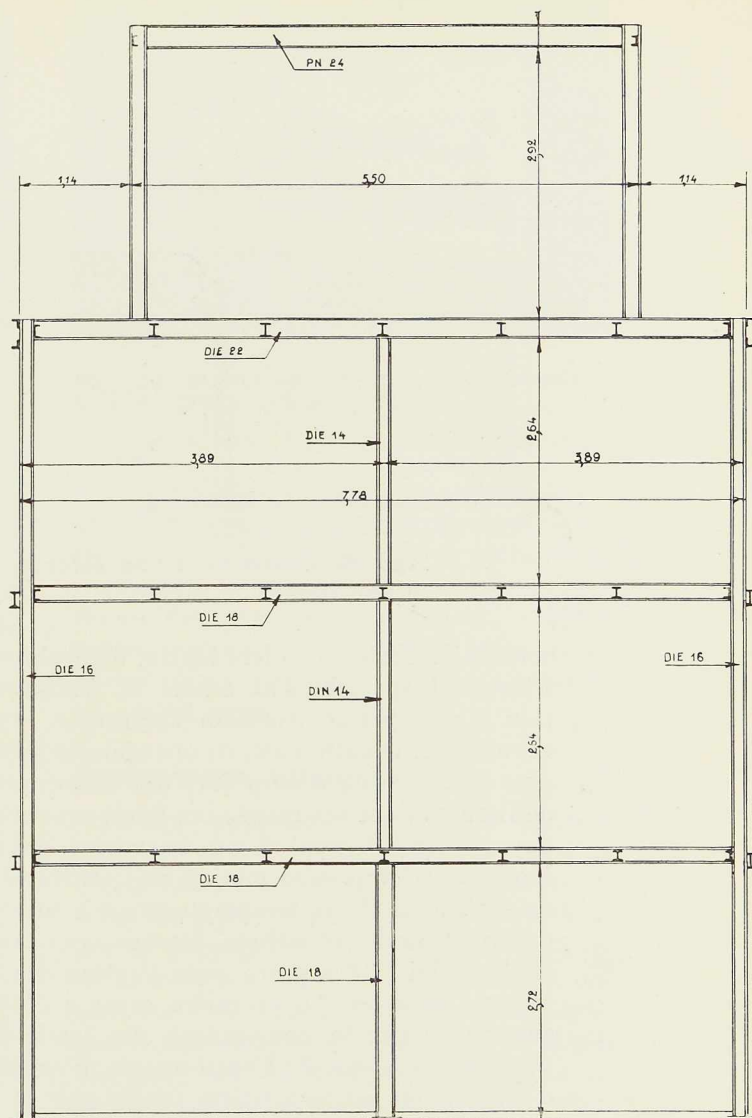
Vue en plan de l'ossature du plancher haut du rez-de-chaussée.
